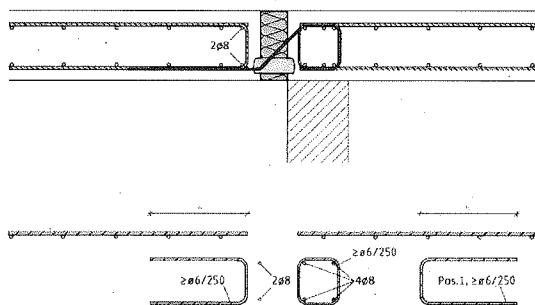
Bewehrungsführung Q bei direkter Lagerung und deckenseitig geschlauften Querkraftstäben
